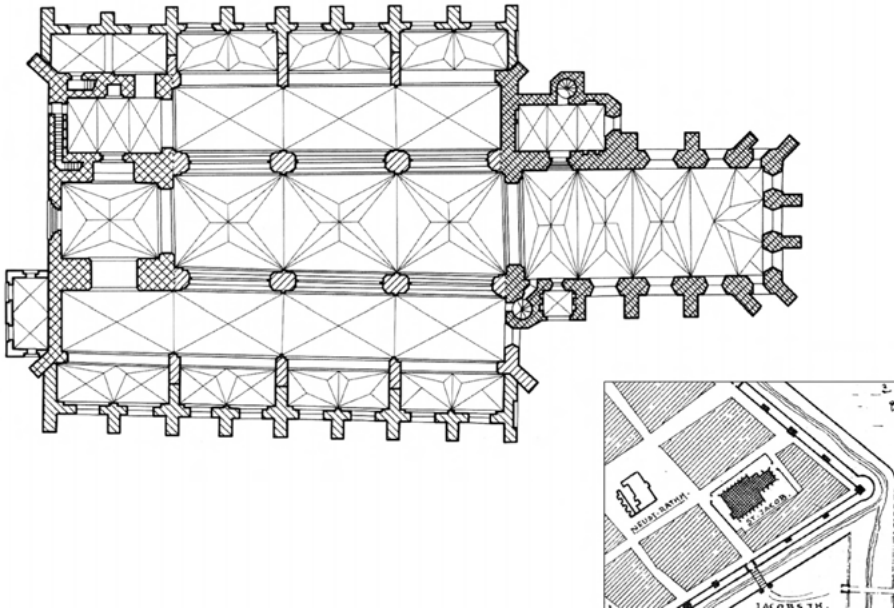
Thorn, St. Jakob, Grundriss und Stadtplanausschnitt mit Lage im Kirchhof
